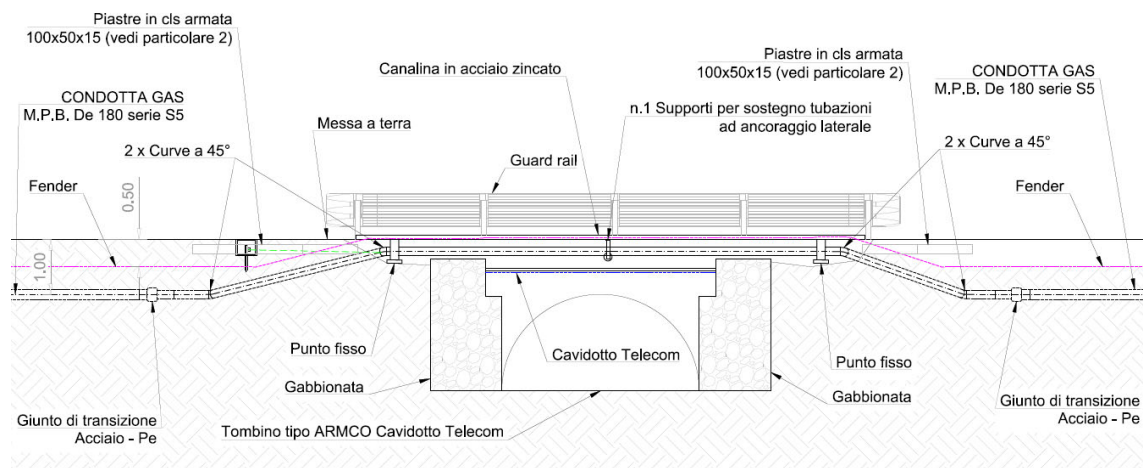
Sezione di progetto 1 – Attraversamento Rio Cintroxu
